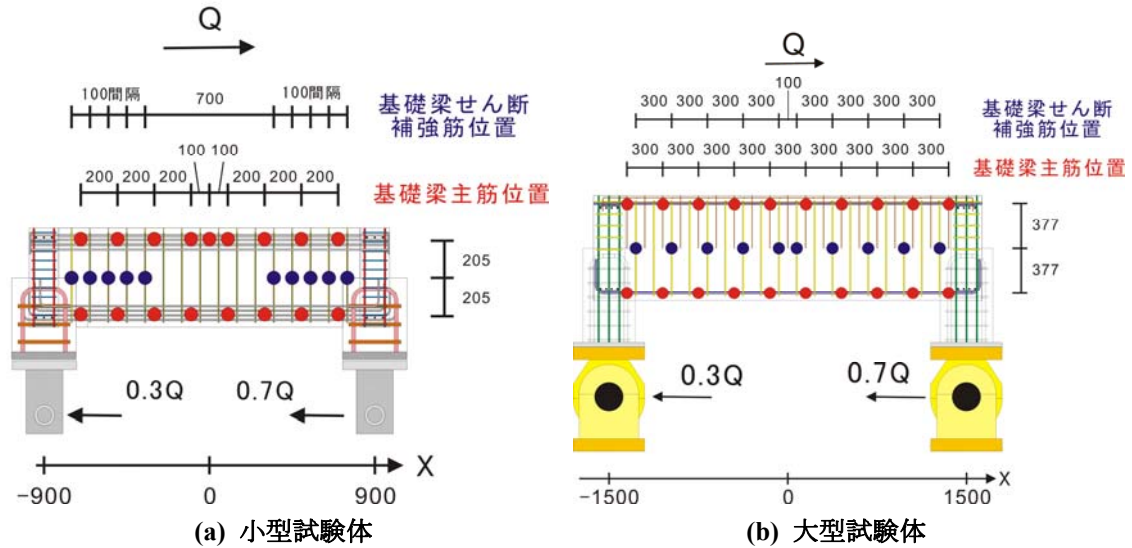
基礎梁主筋、せん断補強筋の歪ゲージ添付位置 (単位: mm)
